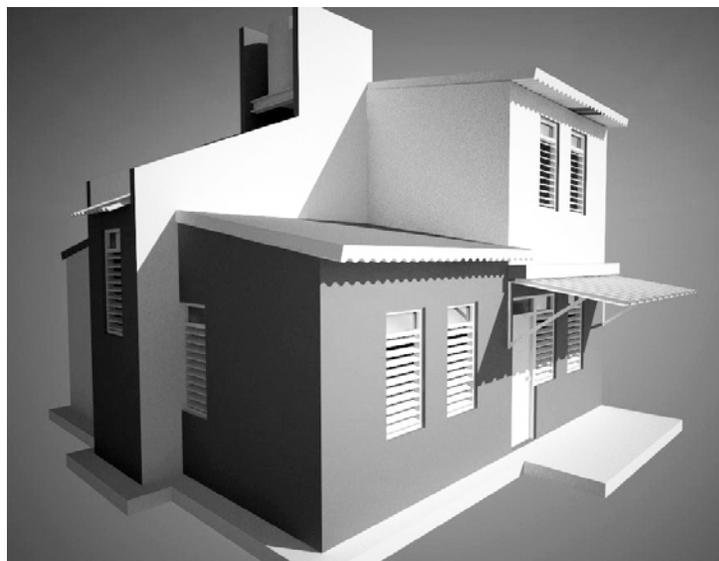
Propuesta de Vivienda evolutiva con núcleo refugio con techos de asbesto cemento convertidos en losas de hormigón armado. Fuente: Autor.
